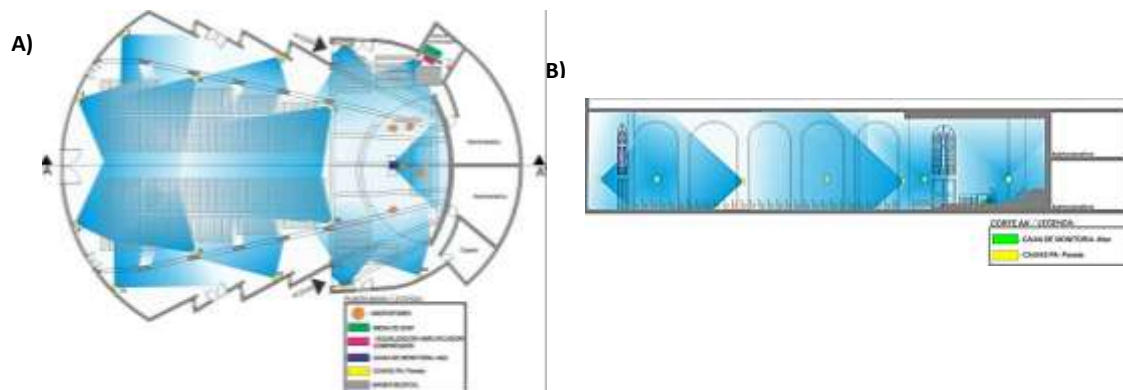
Distribuição sonorização artificial da Concatedral: (A) planta baixa; (B) Corte transversal.
